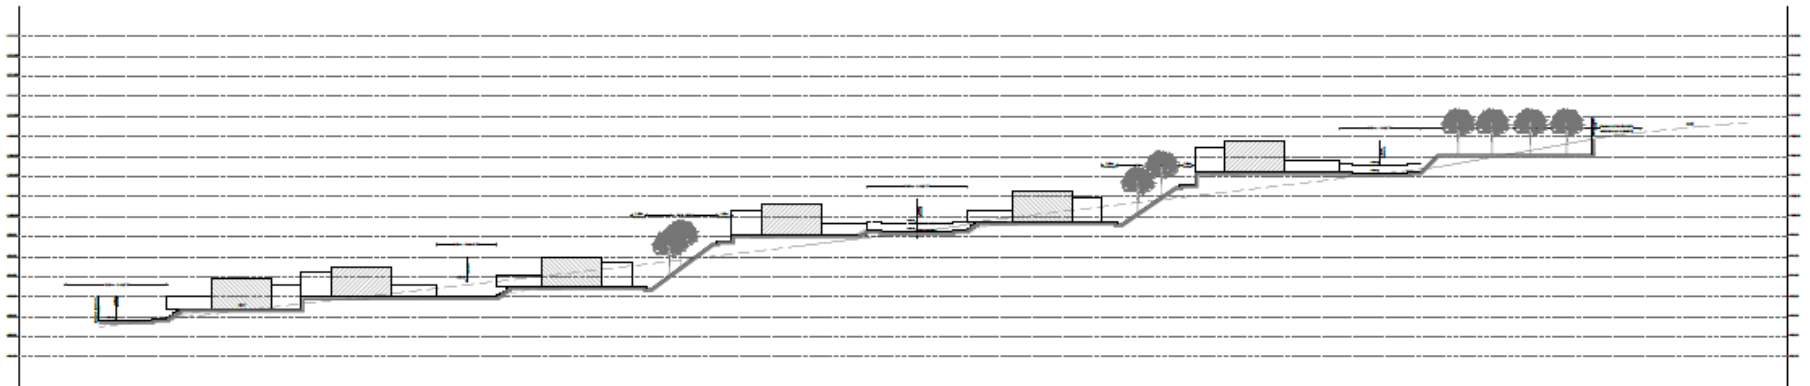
Implantación Planta, Perfil Corte y Relleno. Ilustre Municipio de Ibarra. (Duque, 2016).
